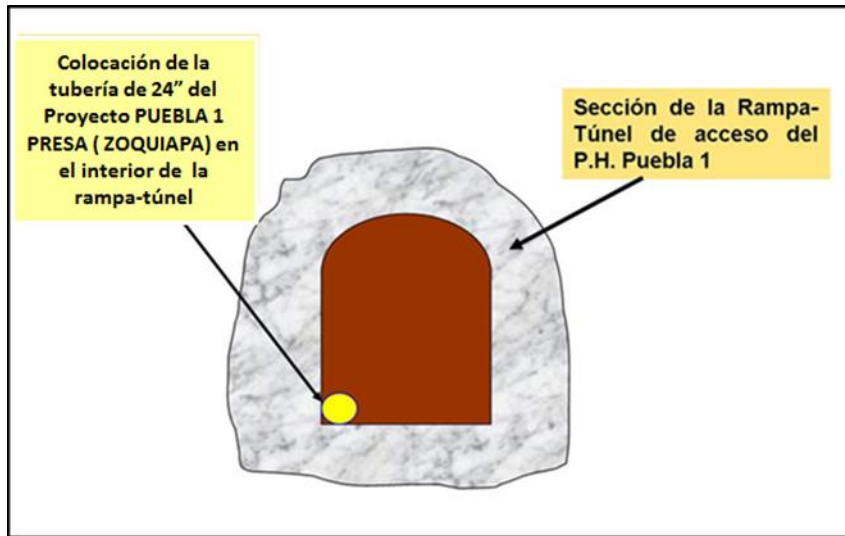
Colocación de la tubería dentro de la Rampa-Túnel
